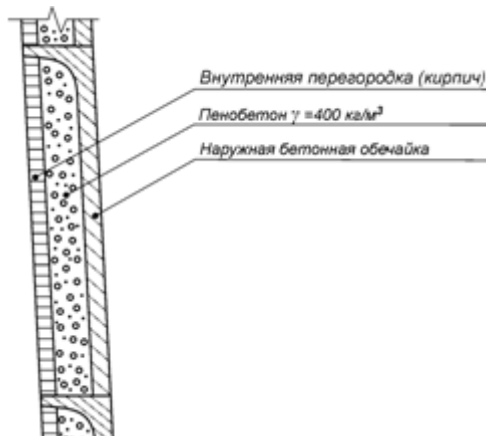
Разрез дымовой трубы НЛМК, утепленной пенобетоном плотностью 400 кг/м³
